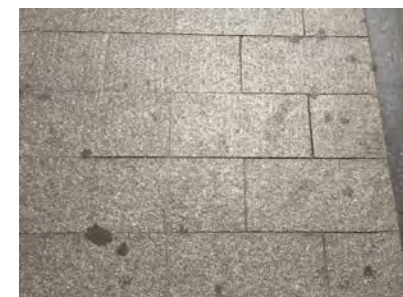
Pavimento existente en la calle Bolsería y calle Quart
